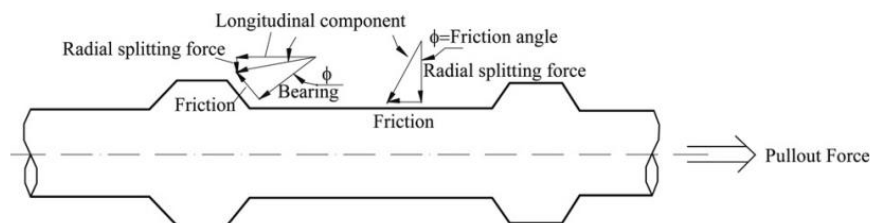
Mécanismes d'ancrage d'une barre d'armature dans le béton (Wang, 2009)
